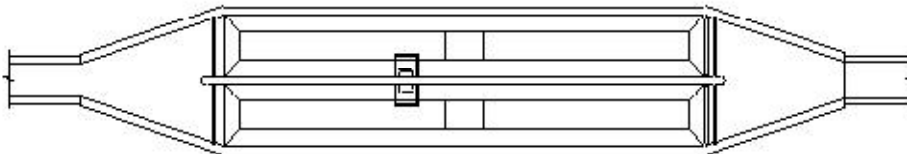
Figura XIX. Desarenador de dos unidades en paralelo (planta).
